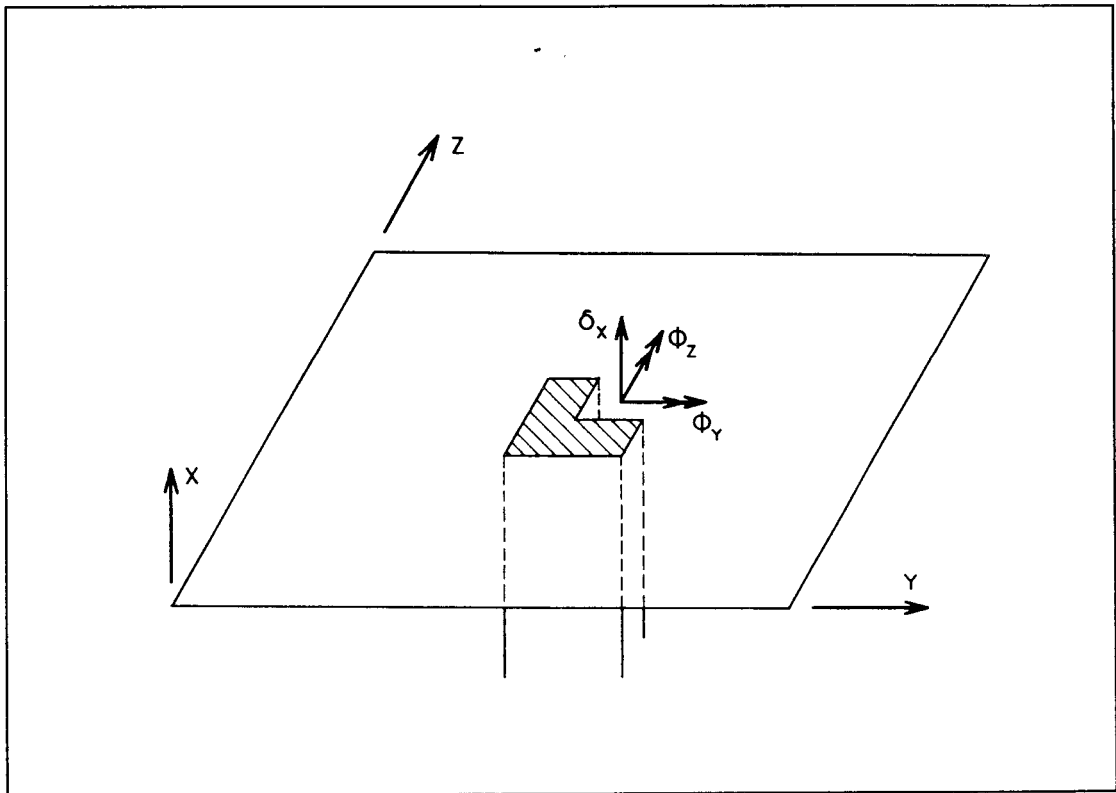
Coordenadas deslocamentos do nó de pilar na subestrutura.
